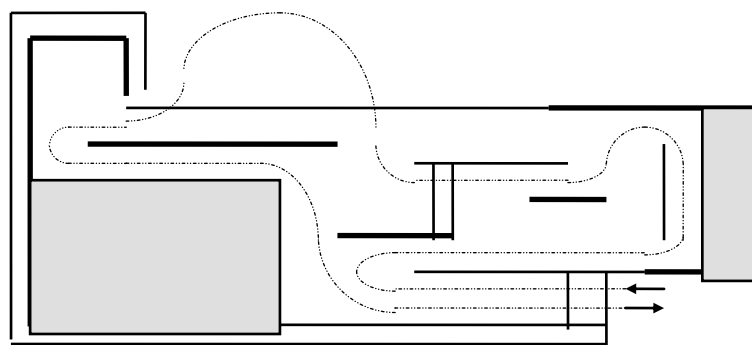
Planta esquemática del Pabellón de Barcelona 1929
